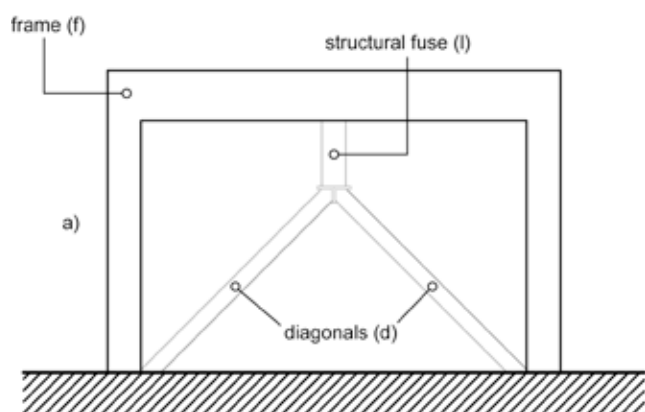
Schema dei controventi eccentrici ad "Y" [3]
